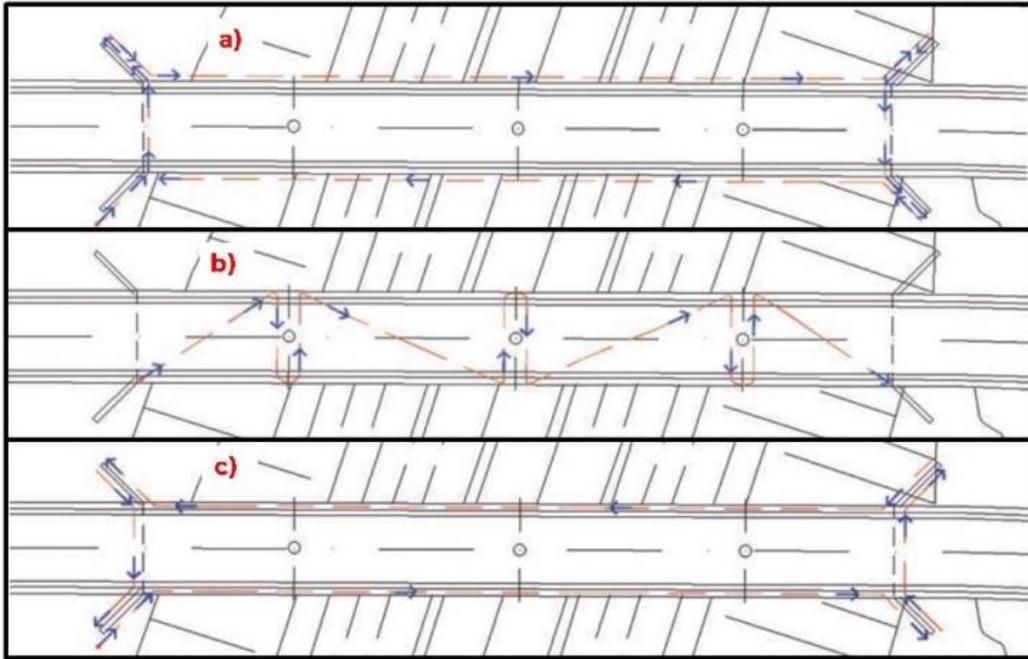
a) Inspección perimetral inferior. b) Inspección Zigzag inferior. c) Inspección de la cara superior del tablero y equipamientos.
